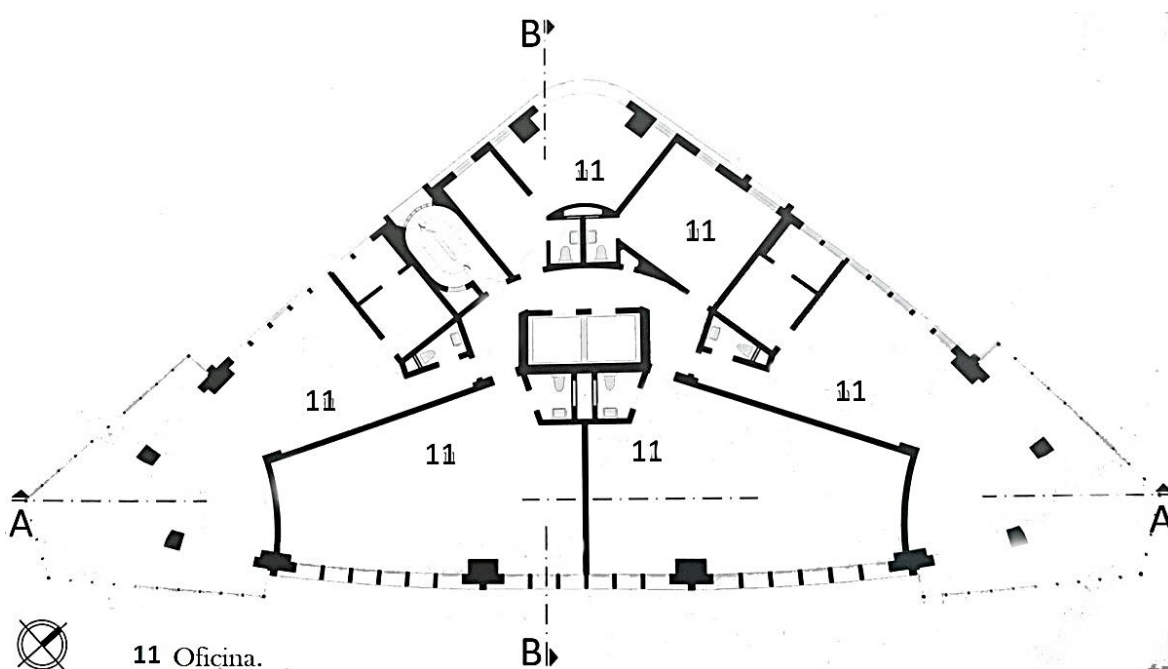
Planta del 3º nivel. Planta elaborada por Viccina (2015).
